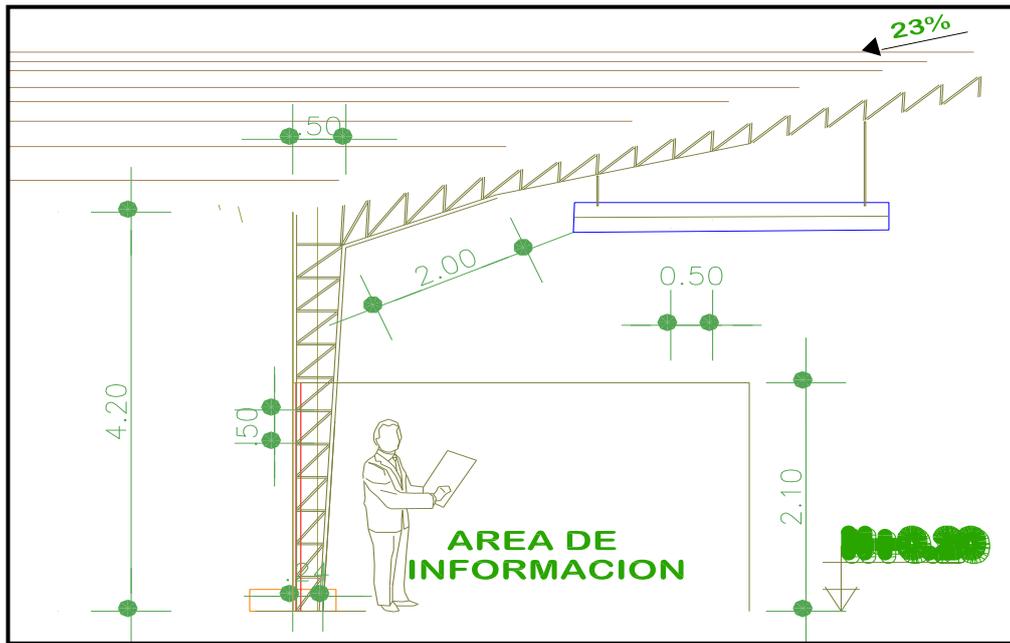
Vista arquitectónica específica del área de información de la planta de reciclaje
